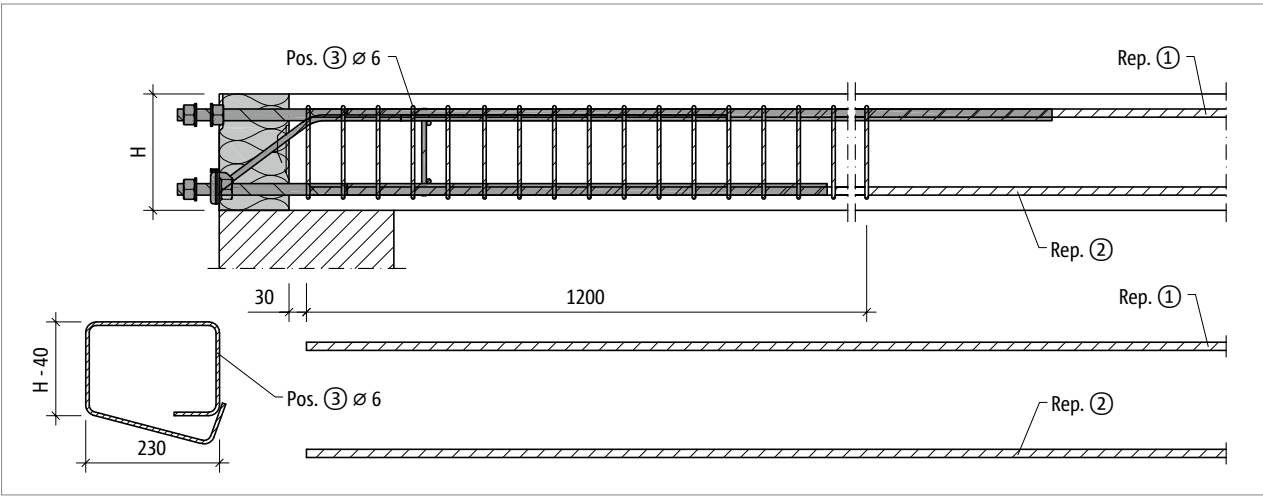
Schöck Isokorb® XT type SK-MM2 : armatures à prévoir par le client avec étrier de Ø 6 mm ; vue en coupe
